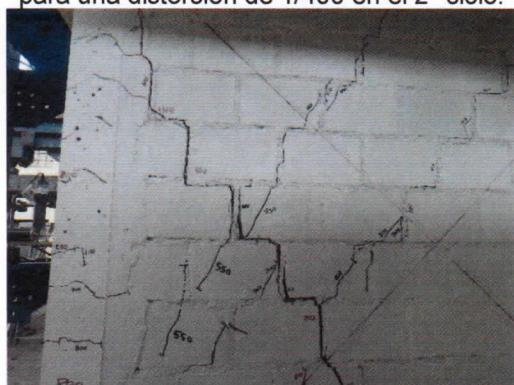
Separación de ladrillo con mortero a lo largo de grieta diagonal en la parte Este de la cara Norte para una distorsión de 1/300.
